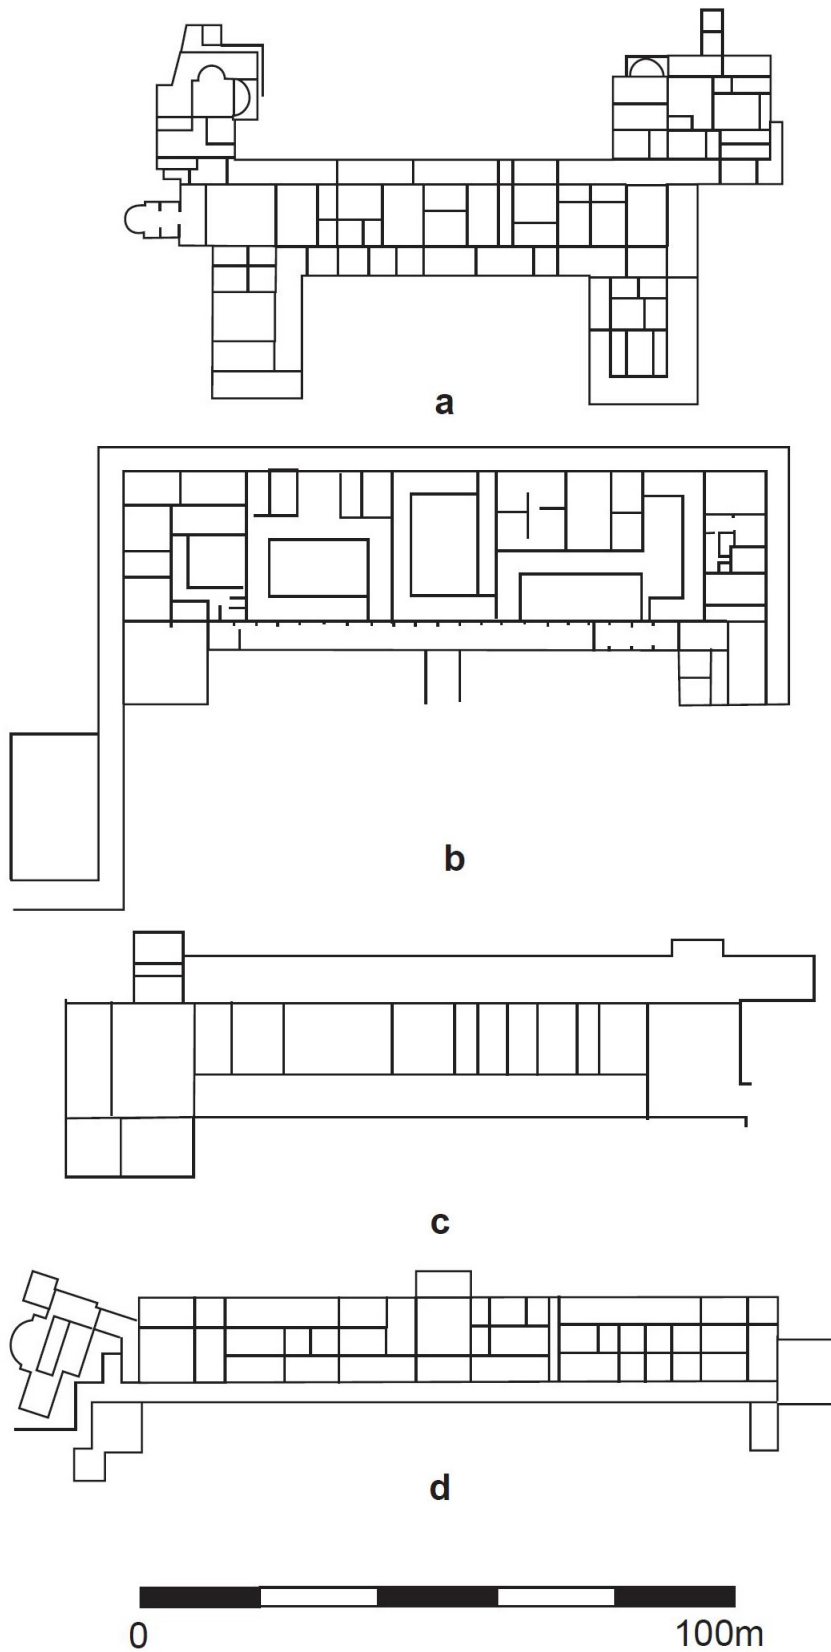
Grundrissvergleich von Hauptgebäuden in Axialanlagen.
